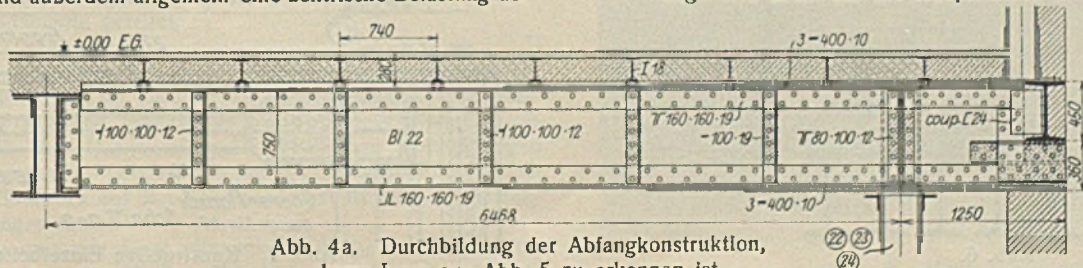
Durchbildung der Abfangkonstruktion, deren Lage aus Abb. 5 zu erkennen ist.
